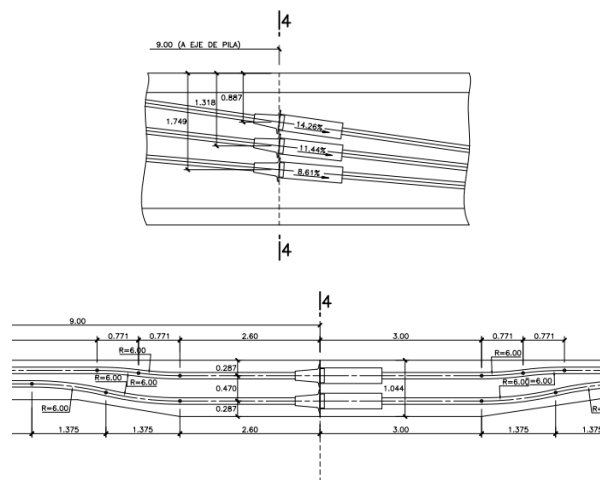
Alzado y planta del frente de fase del Viaducto de Cortijo de Roperos.
